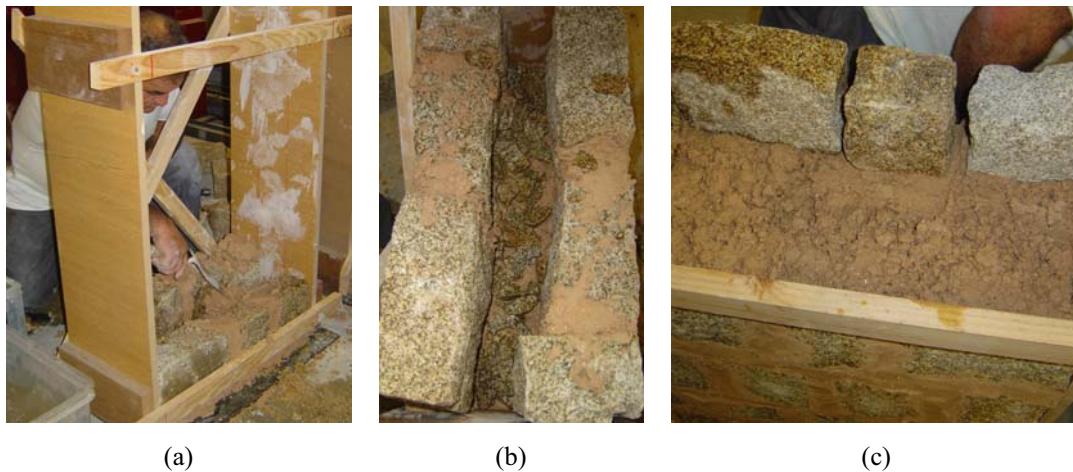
Construção de uma parede de alvenaria de três panos: (a) execução da primeira fiada; (b) execução de uma camada de cascalho do pano interno; (c) execução de uma camada de argamassa do pano interno.
